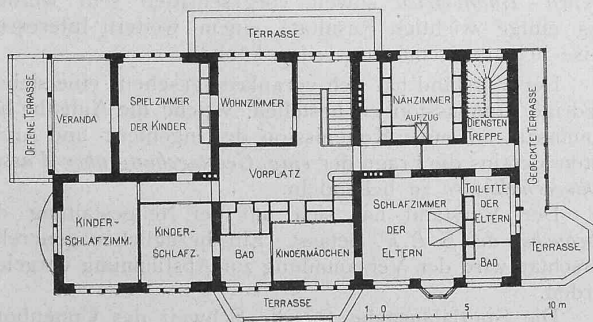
Grundriss vom Obergeschoss. — Masstab 1 : 400.
